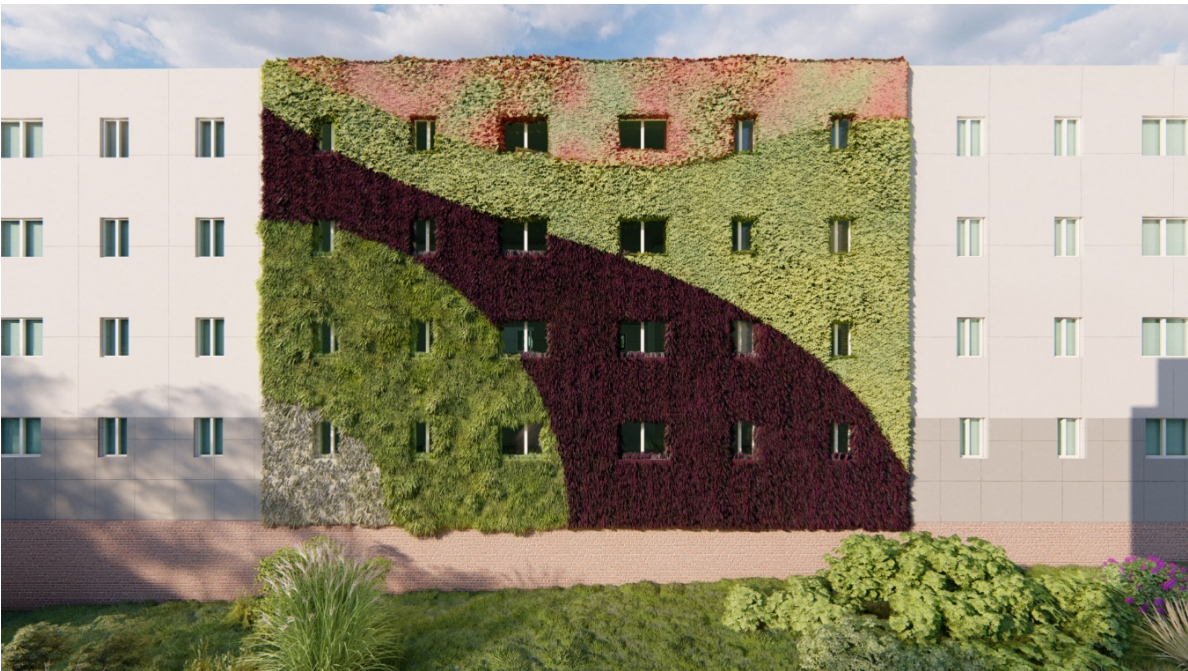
Vista ortogonal de la fachada este del edificio (elaboración propia)
